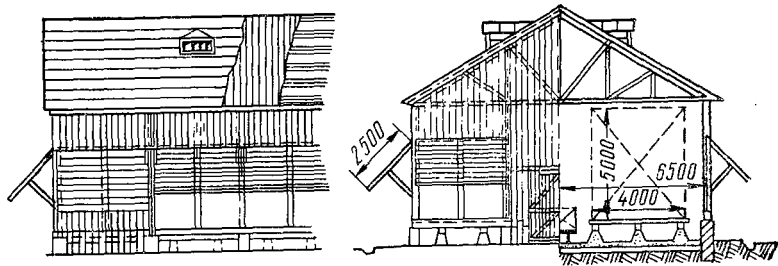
Сарай с регулируемой вентиляцией для сушки заготовок твердых пород
